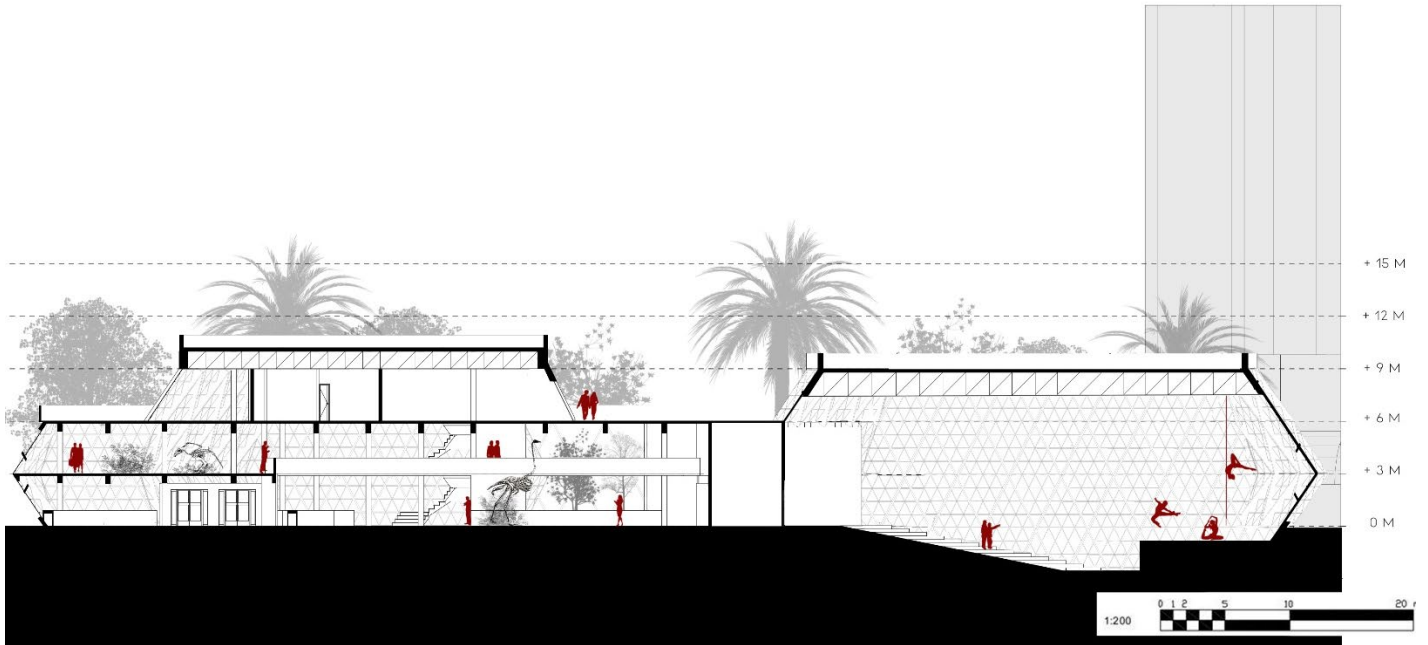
Corte longitudinal B-B'. Elaboración propia.
